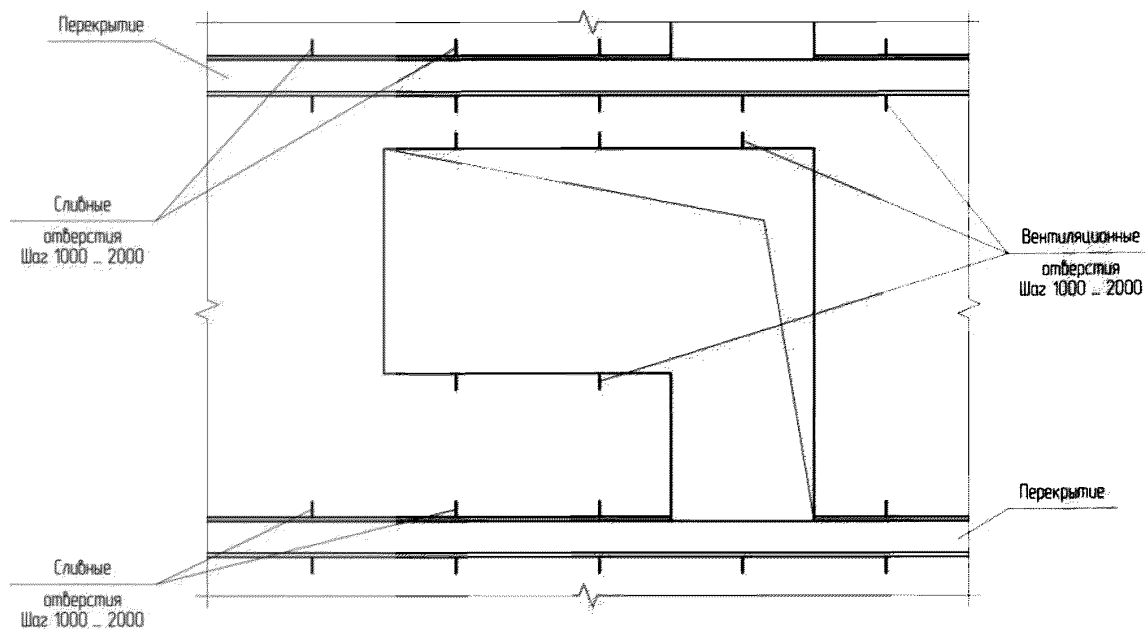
Схема расположения сливных и вентиляционных отверстий в облицовочной кладке
